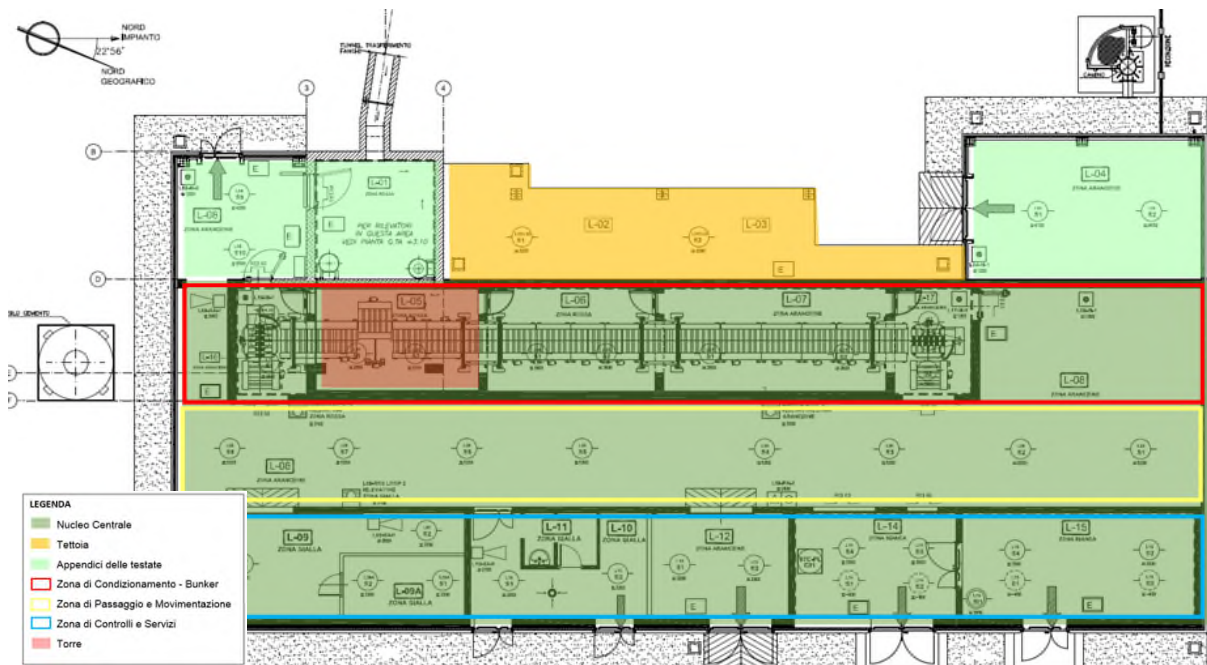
Edificio di Condizionamento - Pianta piano terra
